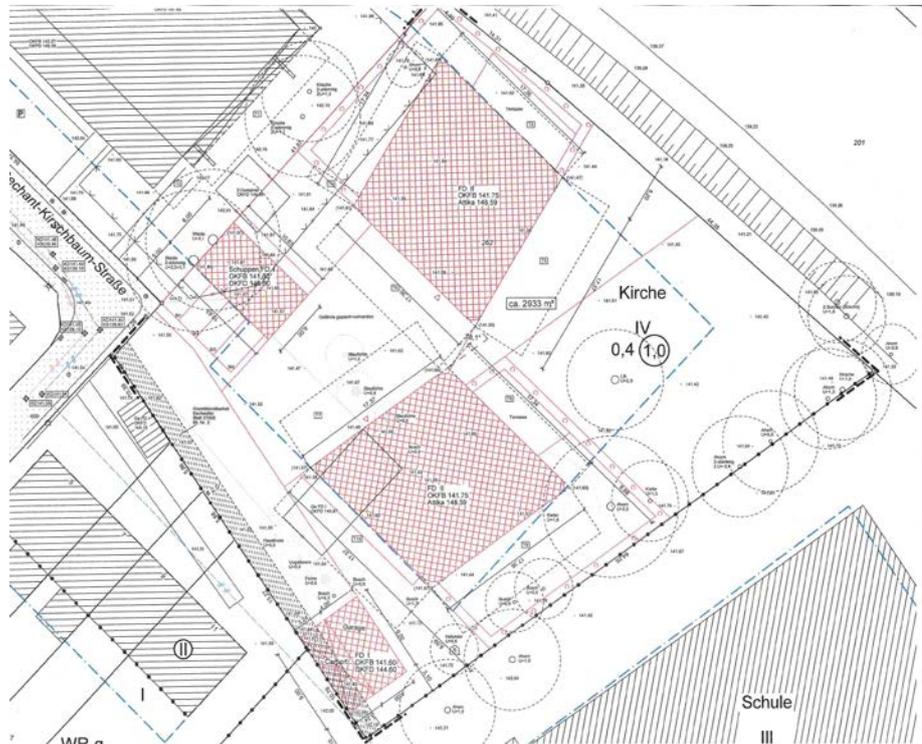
Planung bauliche Erweiterung Haus St. Josef (Quelle: Stadt Eschweiler)
